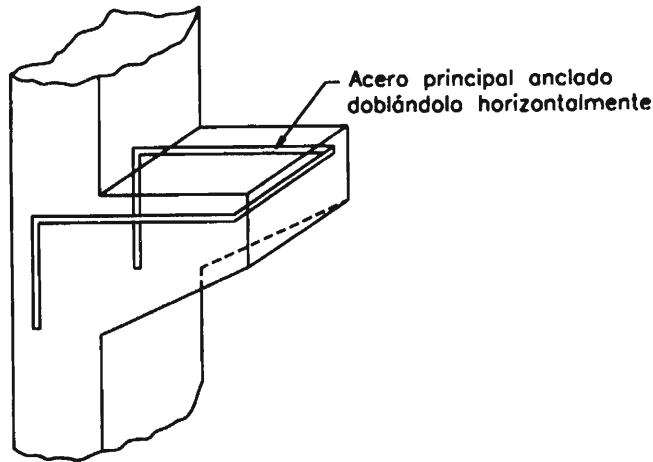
Anclaje horizontal del refuerzo principal en consolas
